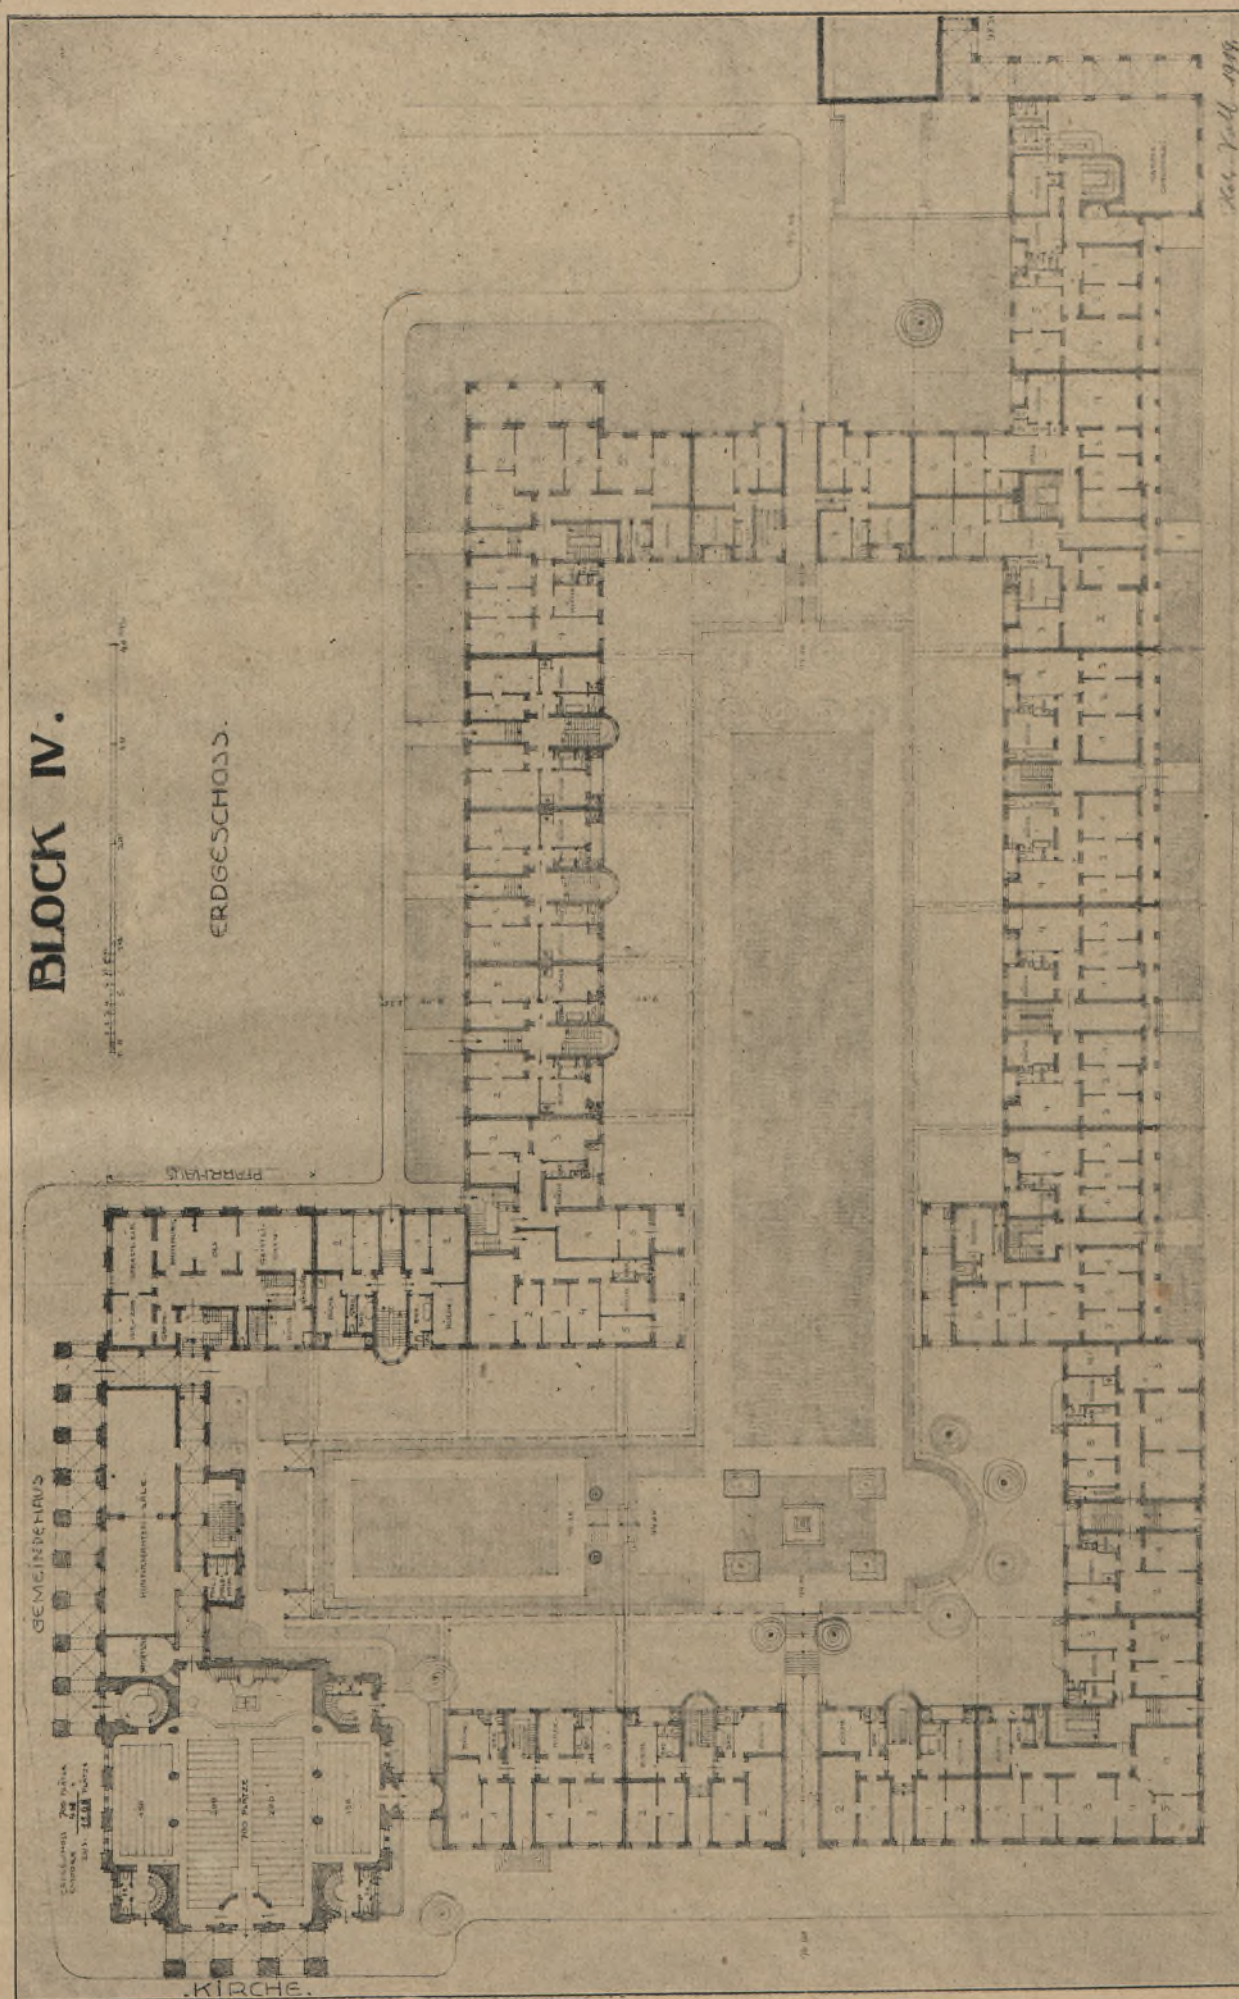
Mannheim. Bebauungsplan für das Baugebiet Schafweide und Altwasser. Erdgeschoßgrundriß von Block IV. Maßstab 1:750.
